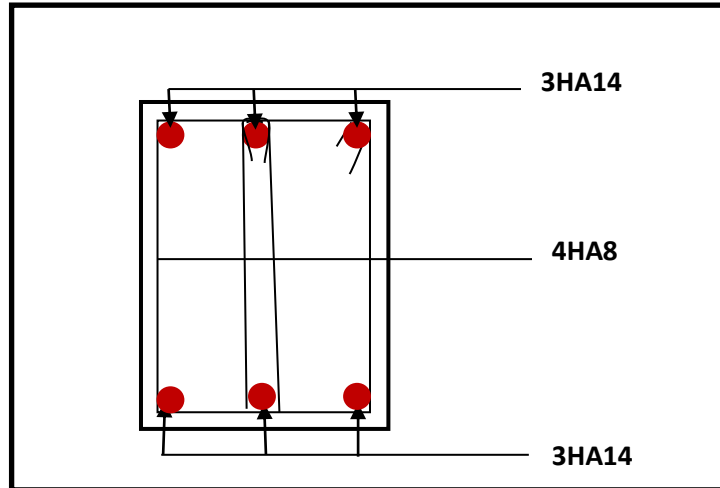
Schéma de ferraillage aux appuis d'une poutre principale
